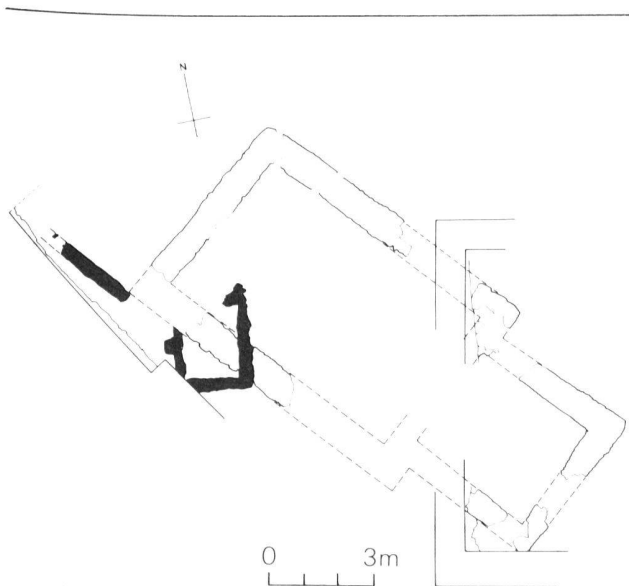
Bourguillon. Plan général. Aménagements extérieurs
